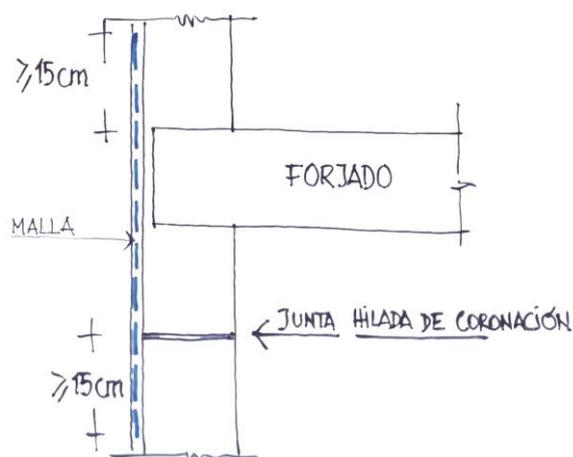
Esquema de encuentro fachada – forjado
